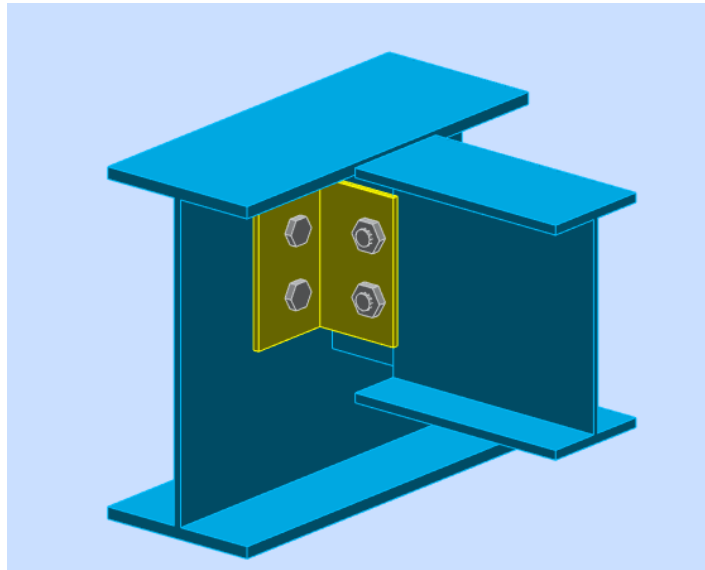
« Vue de l'assemblage poutre-solive fait par Robot »
